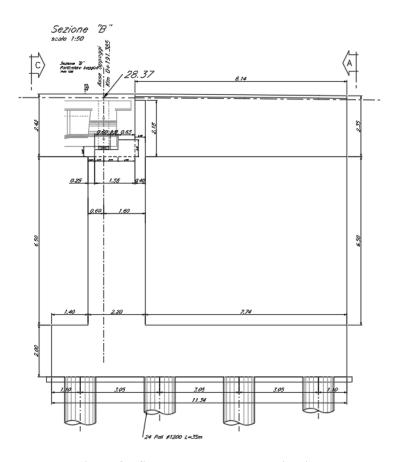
Spalla B – Prospetto longitudinale
